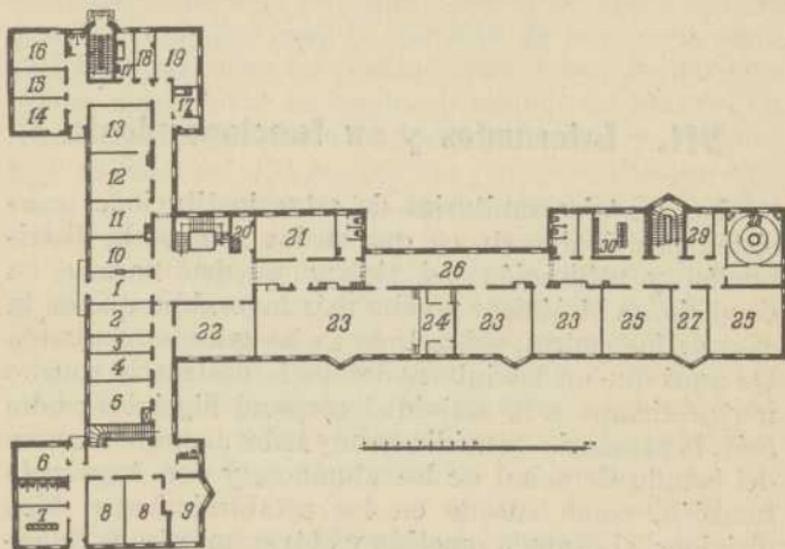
Planta de la residencia infantil de Luneburg (Alemania)
